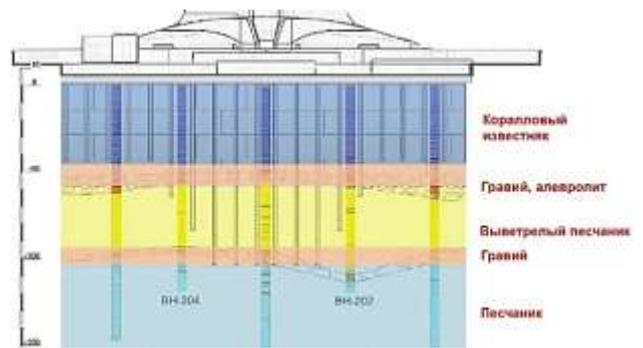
Грунтовые условия площадки строительства «Кингдом Тауэр»
